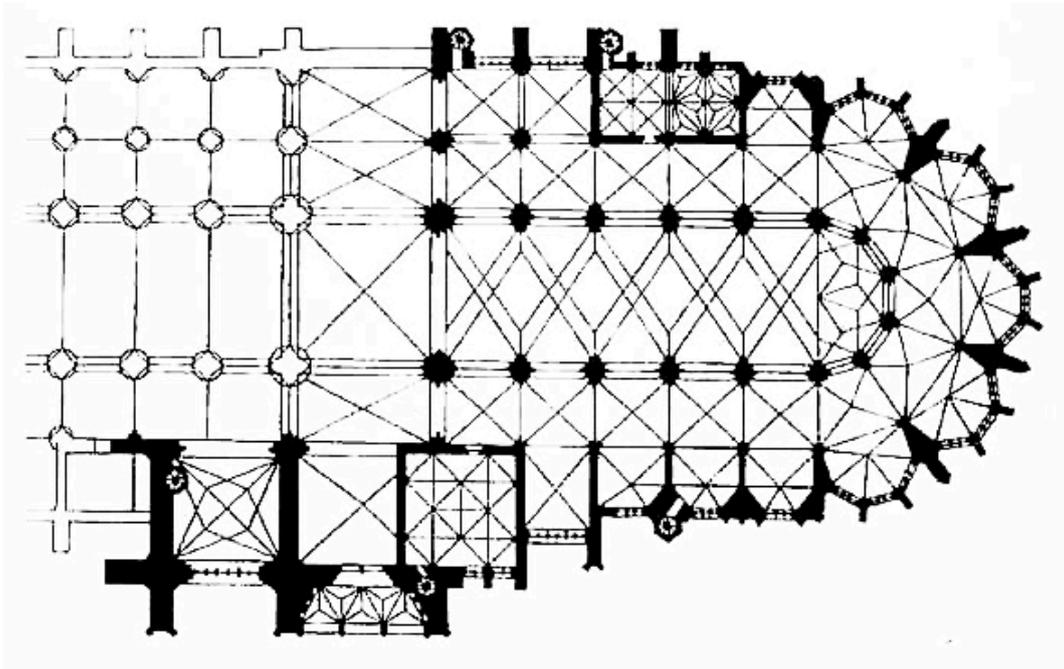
Grundriss St. Veit, Prag, 1345-1385.
